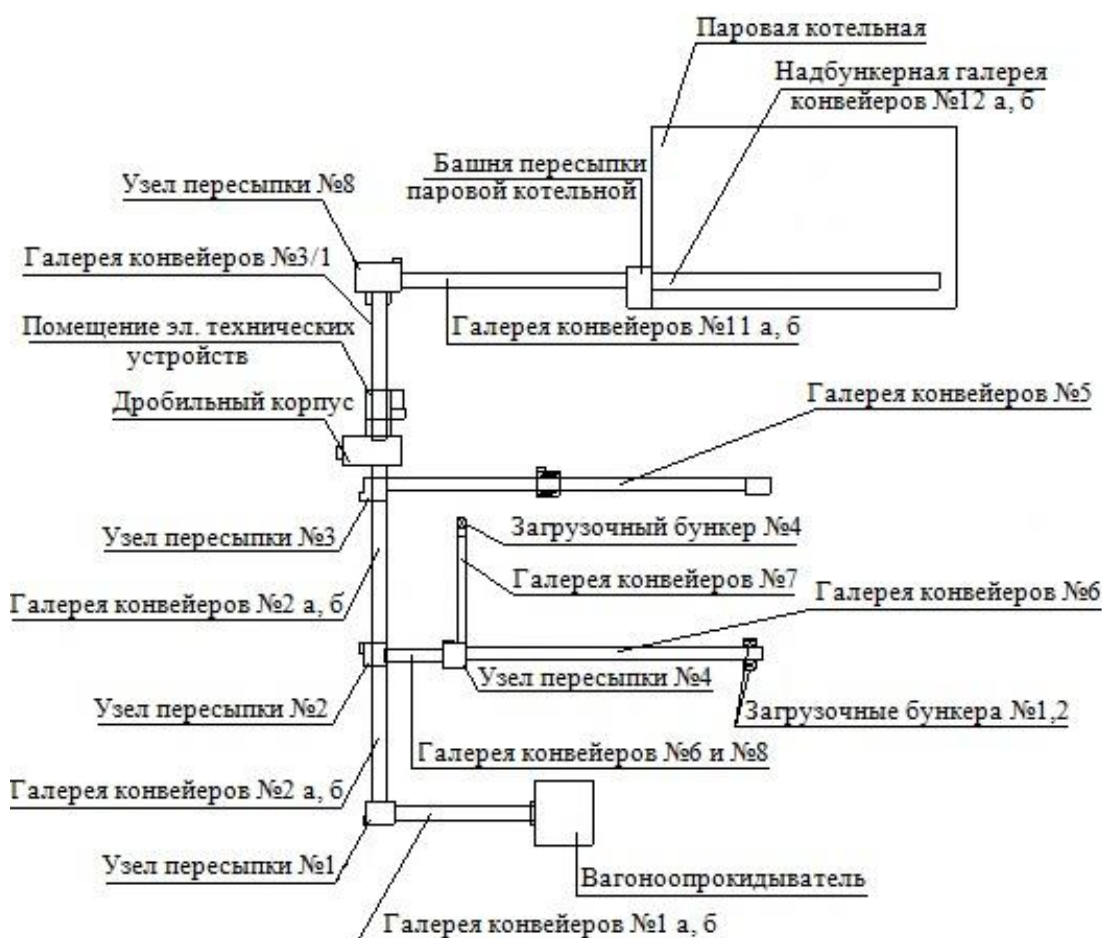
Схема перегрузки угля на Красноярской ТЭЦ-4
